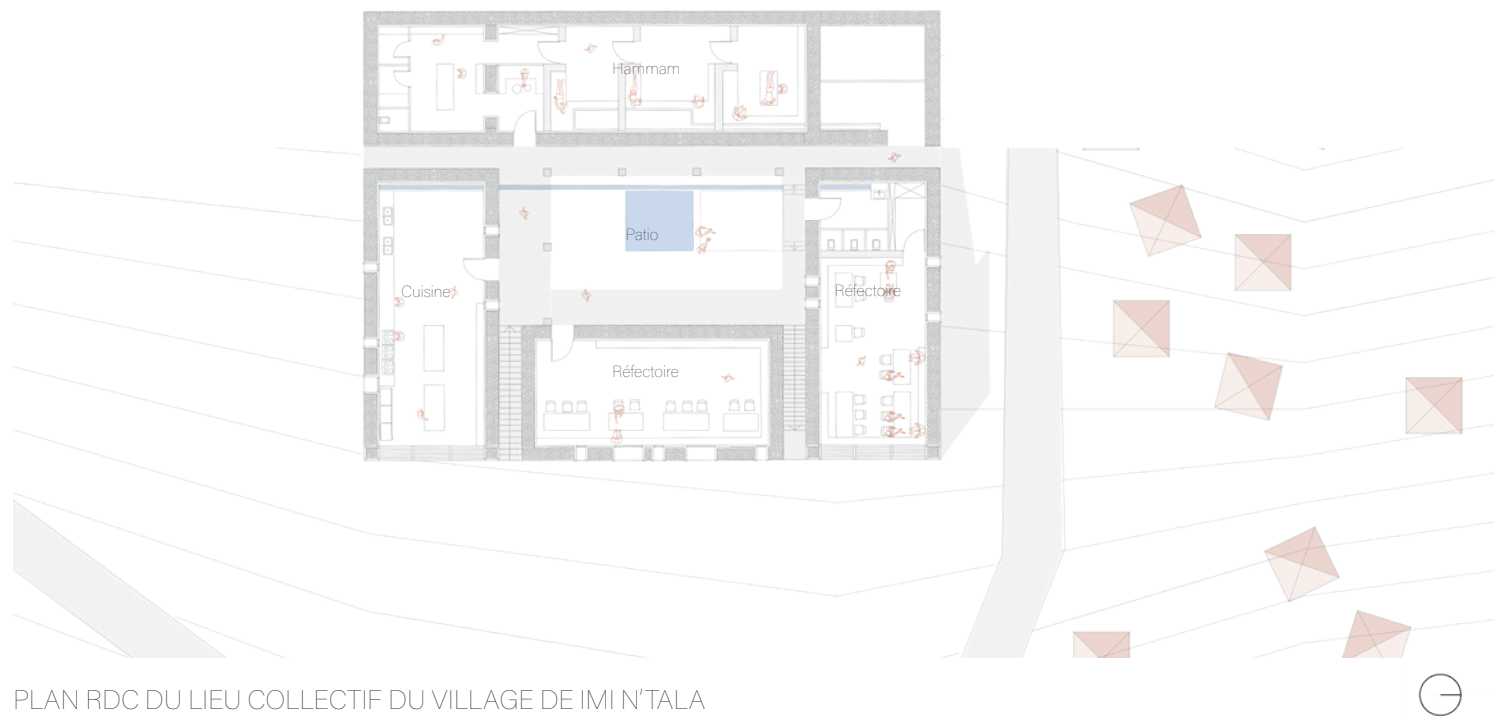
Plan masse Imi N'tala, crédit de l'auteur.
